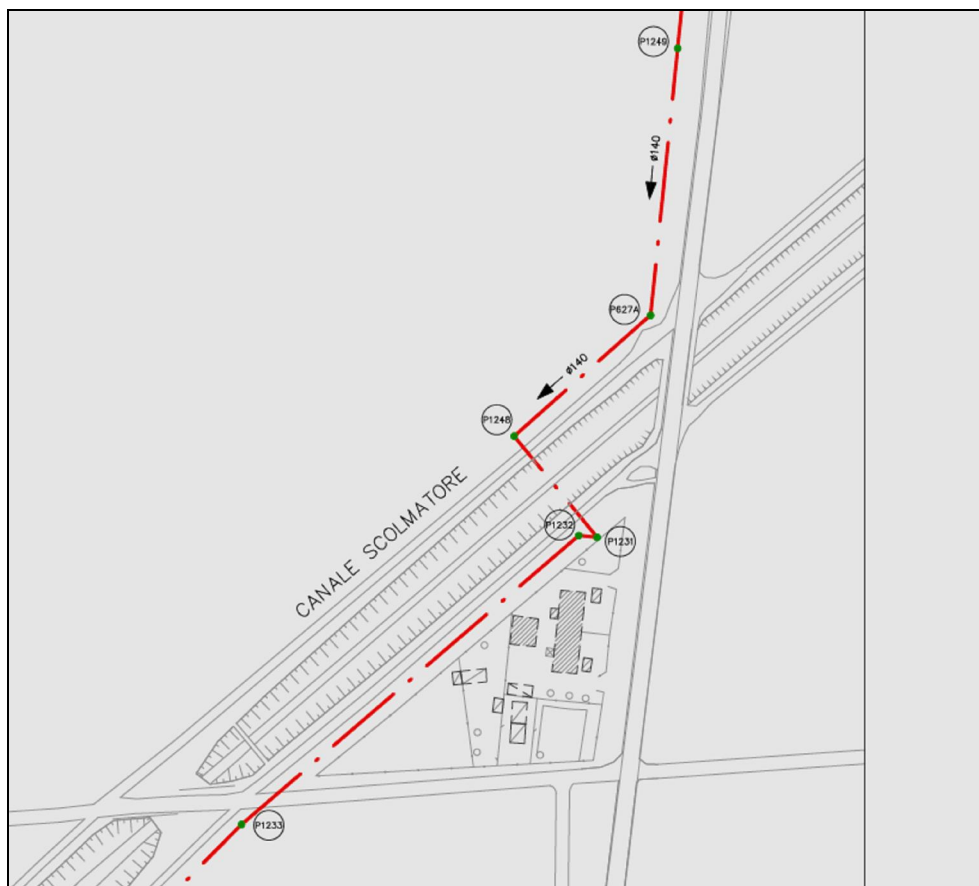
tracciato del collettore consortile. Dettaglio nei pressi dell'attraversamento del C.S.N.O.
